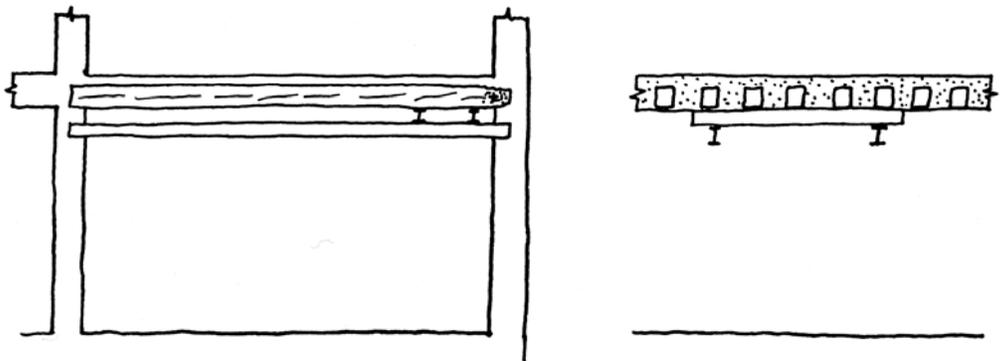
Vigas metálicas para soporte del forjado de madera en un tramo.
